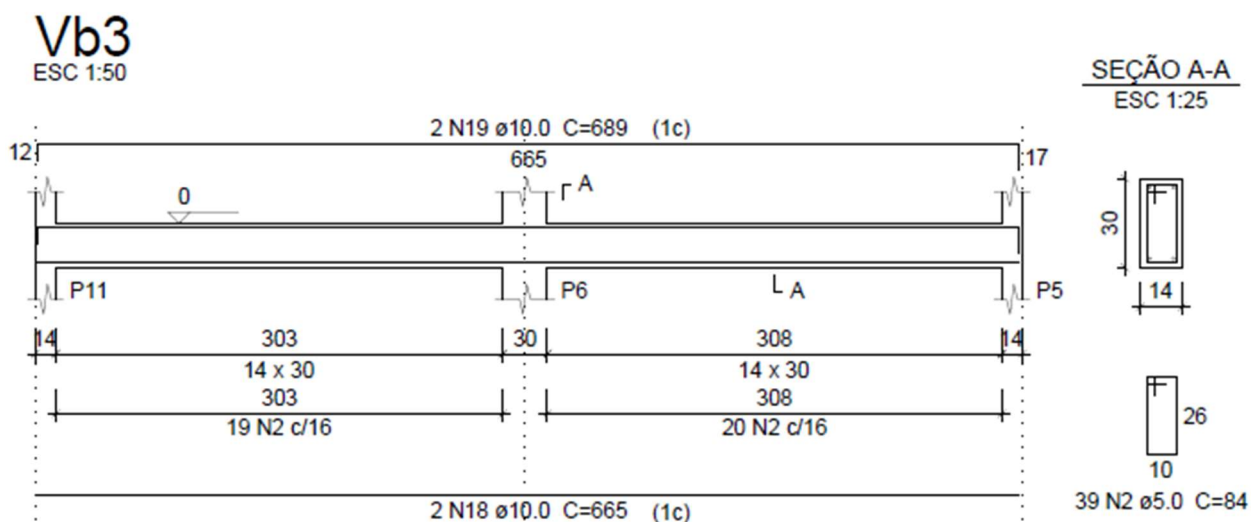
Dimensões da Viga Baldrame e detalhe da armadura long/trans. Vb3
